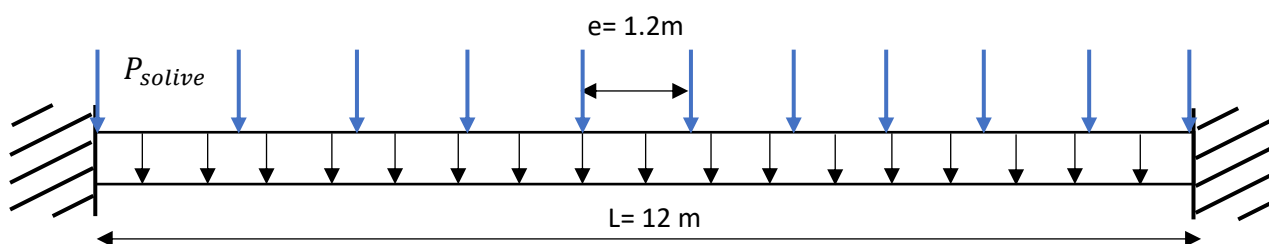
Schéma de la poutre principale de longueur de 12m
